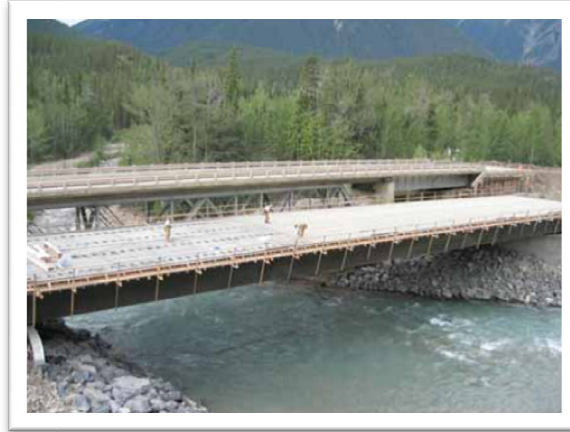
Fase de construcción del Puente Trout River, British Columbia, Canadá.
